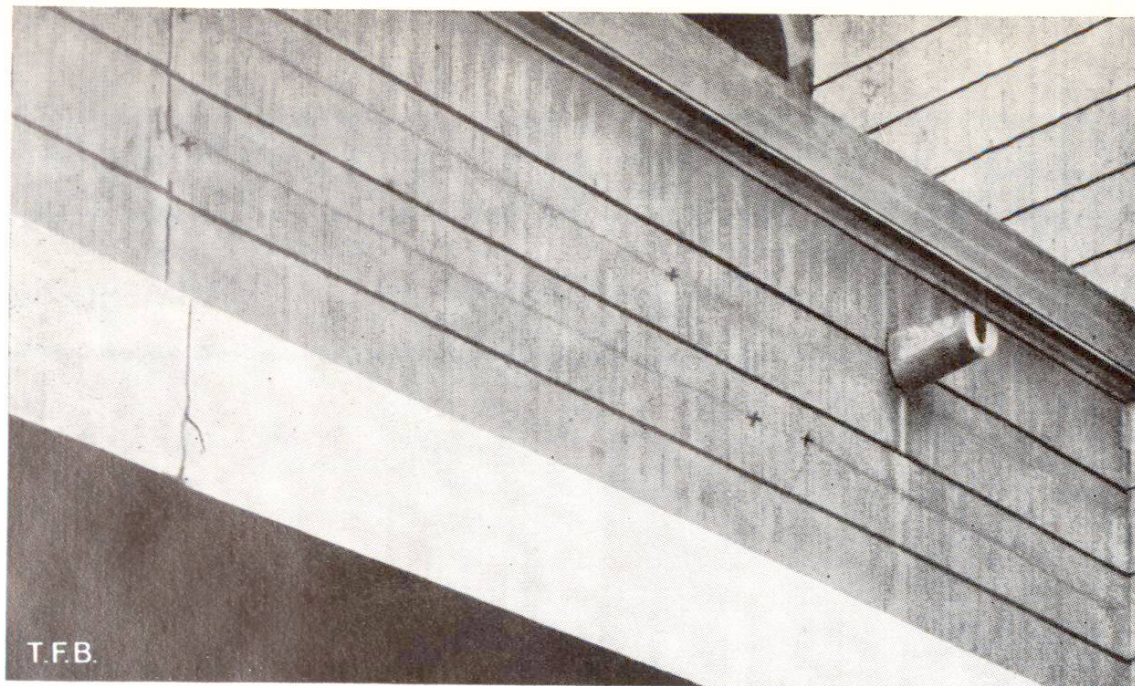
Fissures avec déplacement du béton dans un sommier en béton armé
